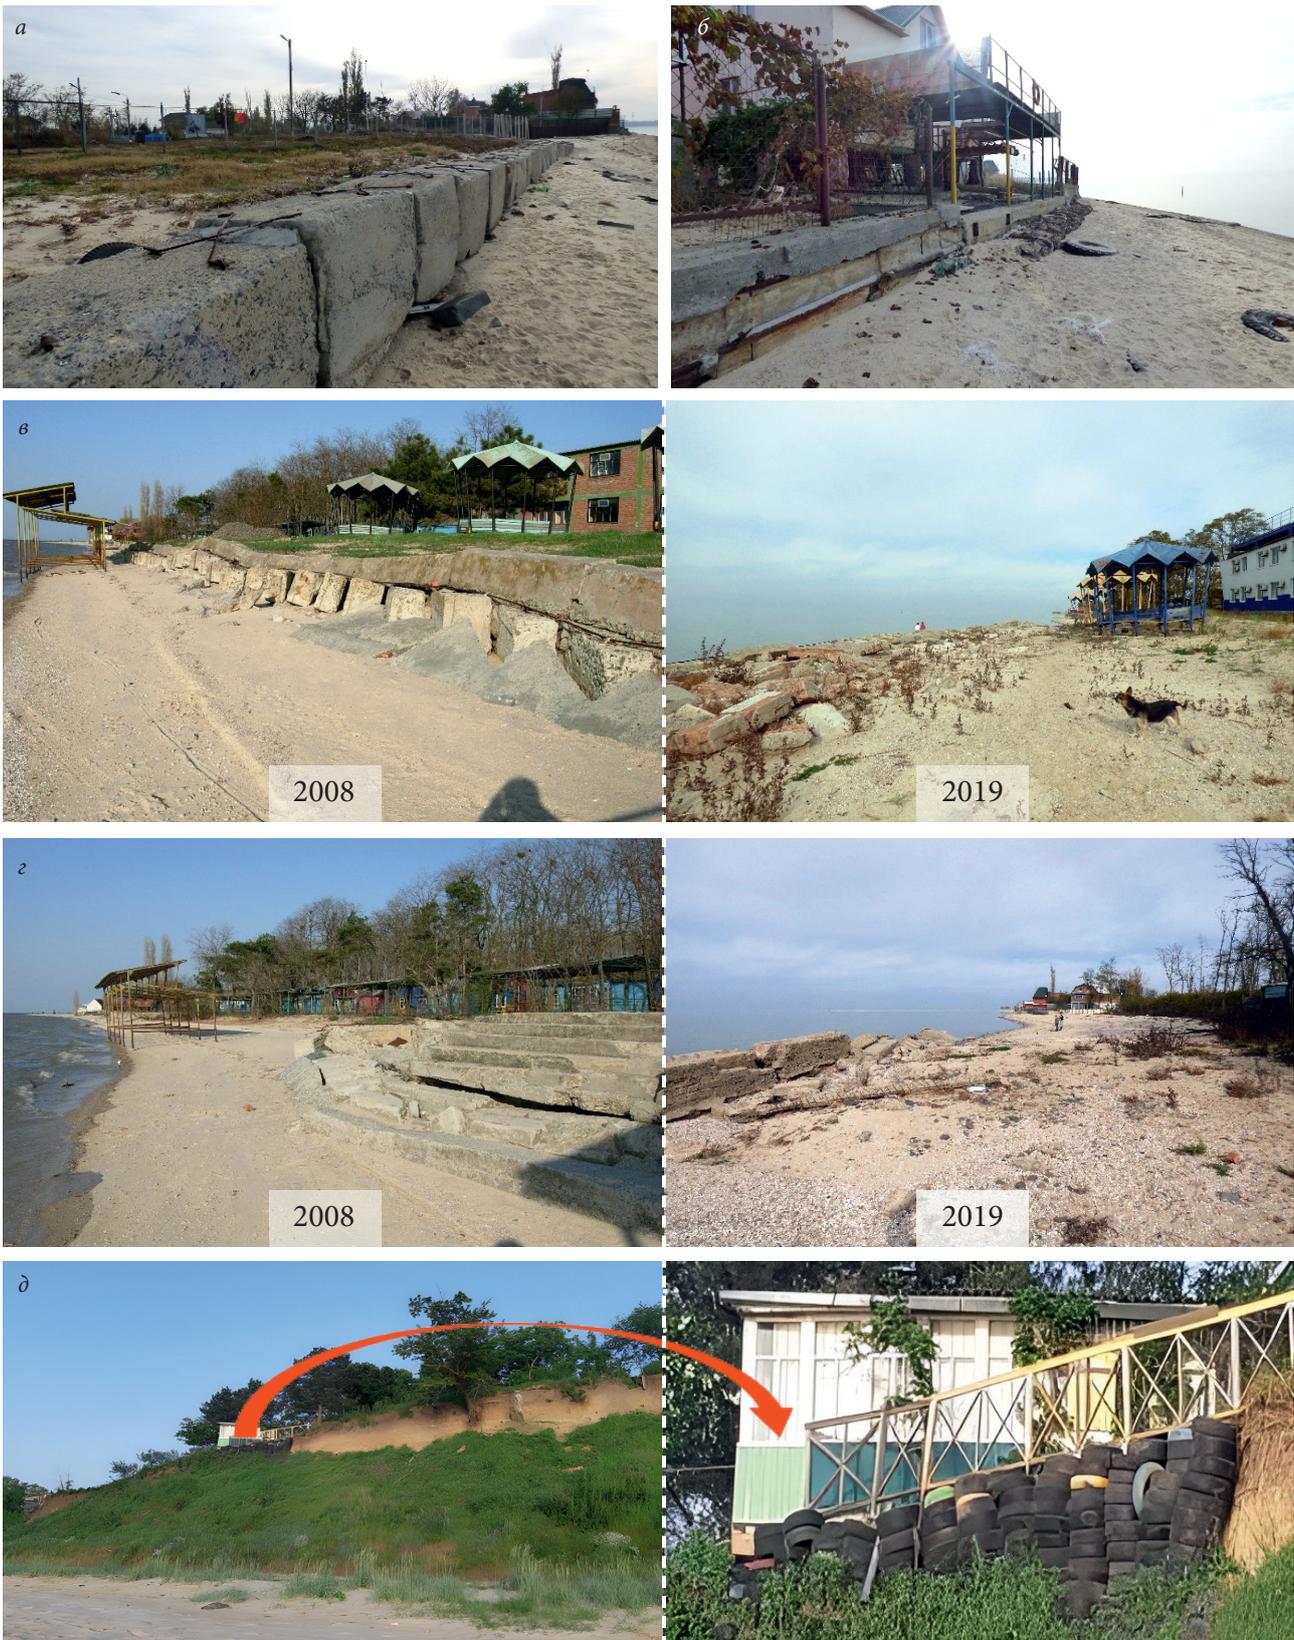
Берегоукрепления на Павло-Очаковской косе: а) бетонная стенка из блоков; б) стенка в виде габионов; в) состояние бетонной стенки в виде блоков; г) нетрадиционный способ защиты – берегоукрепление в верхней части склона с помощью шин в несколько рядов (в северо-западной части)
